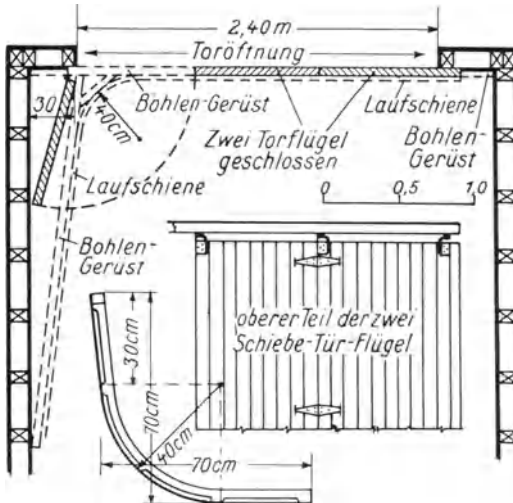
Grundriß eines Garagentores mit eingezeichnete Laufschiene¹⁾.
